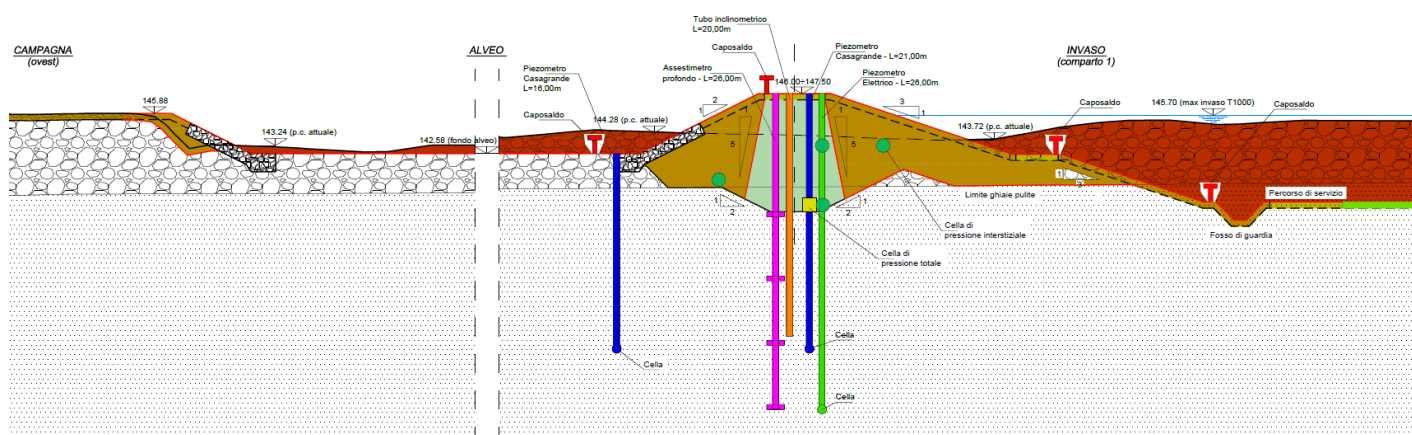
Schema d'ubicazione della strumentazione per il monitoraggio (Sezione tipo 5)
